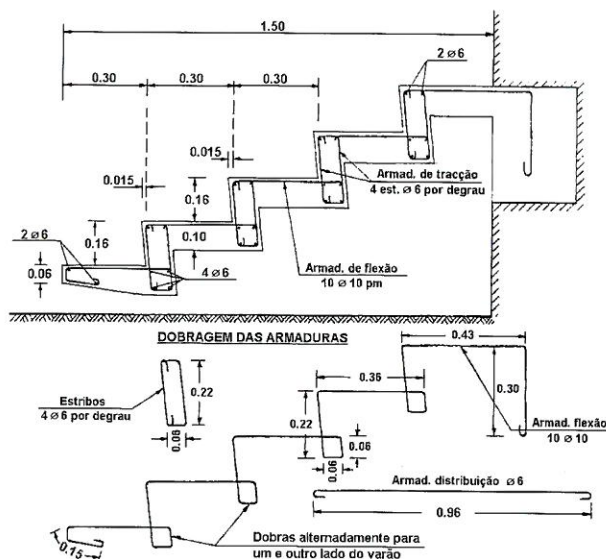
Escadas em balanço - Exemplo 2.1 - Disposições construtivas das armaduras
